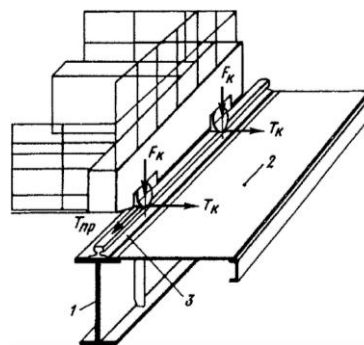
Подкрановые конструкции опорного мостового крана в промышленном строительстве:
